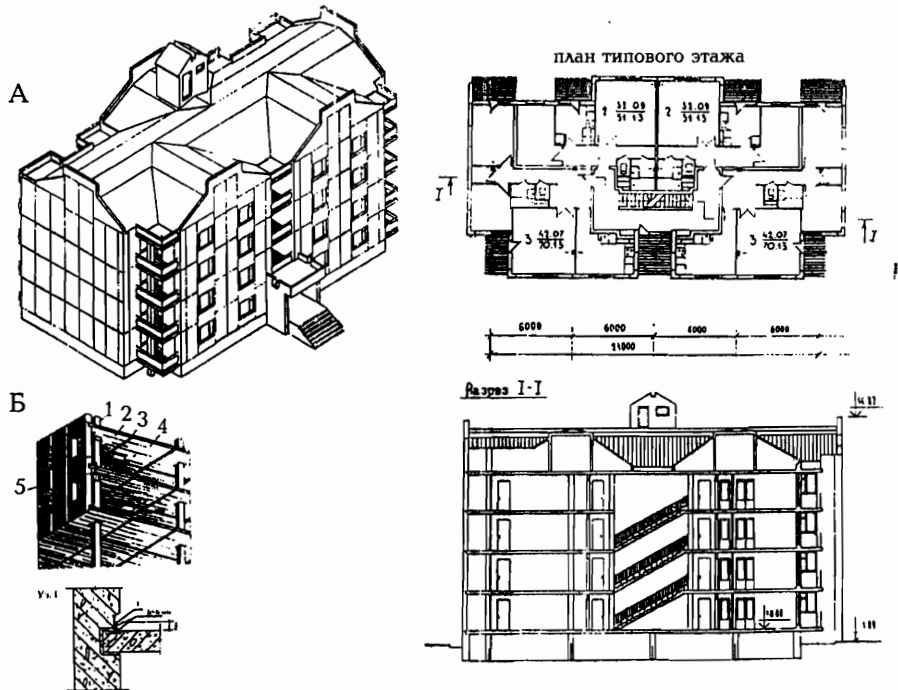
Объемно-планировочные и конструктивные решения зданий серии "КУБ": А – здания со сборными перекрытиями и замоноличиваемыми стыками ("КУБ"-2), Б – здания с монолитной частью перекрытий ("КУБ"-2М): 1 – сборные колонны; 2 – сборные надколонные плиты; 3 – монолитные стыки перекрытий; 4 – сборные межколонные плиты; 5 – стеновые панели
